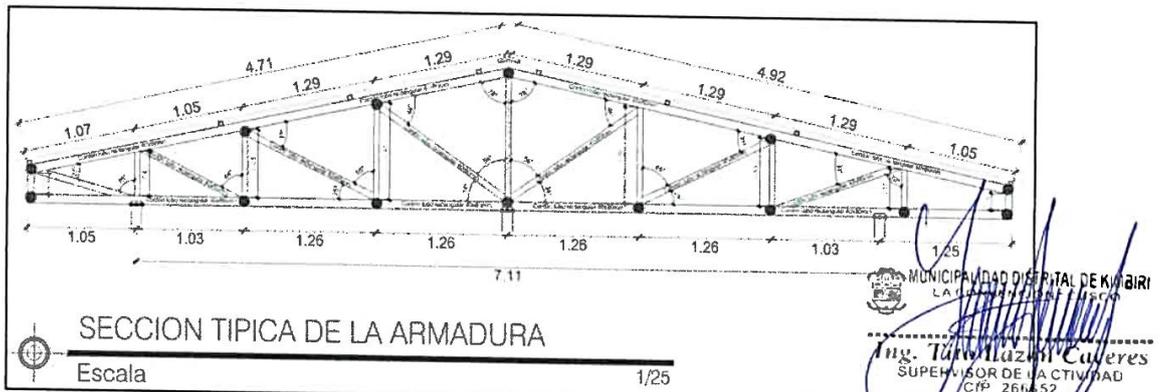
Plano de sección de armaduras de estructuras metálicas.
